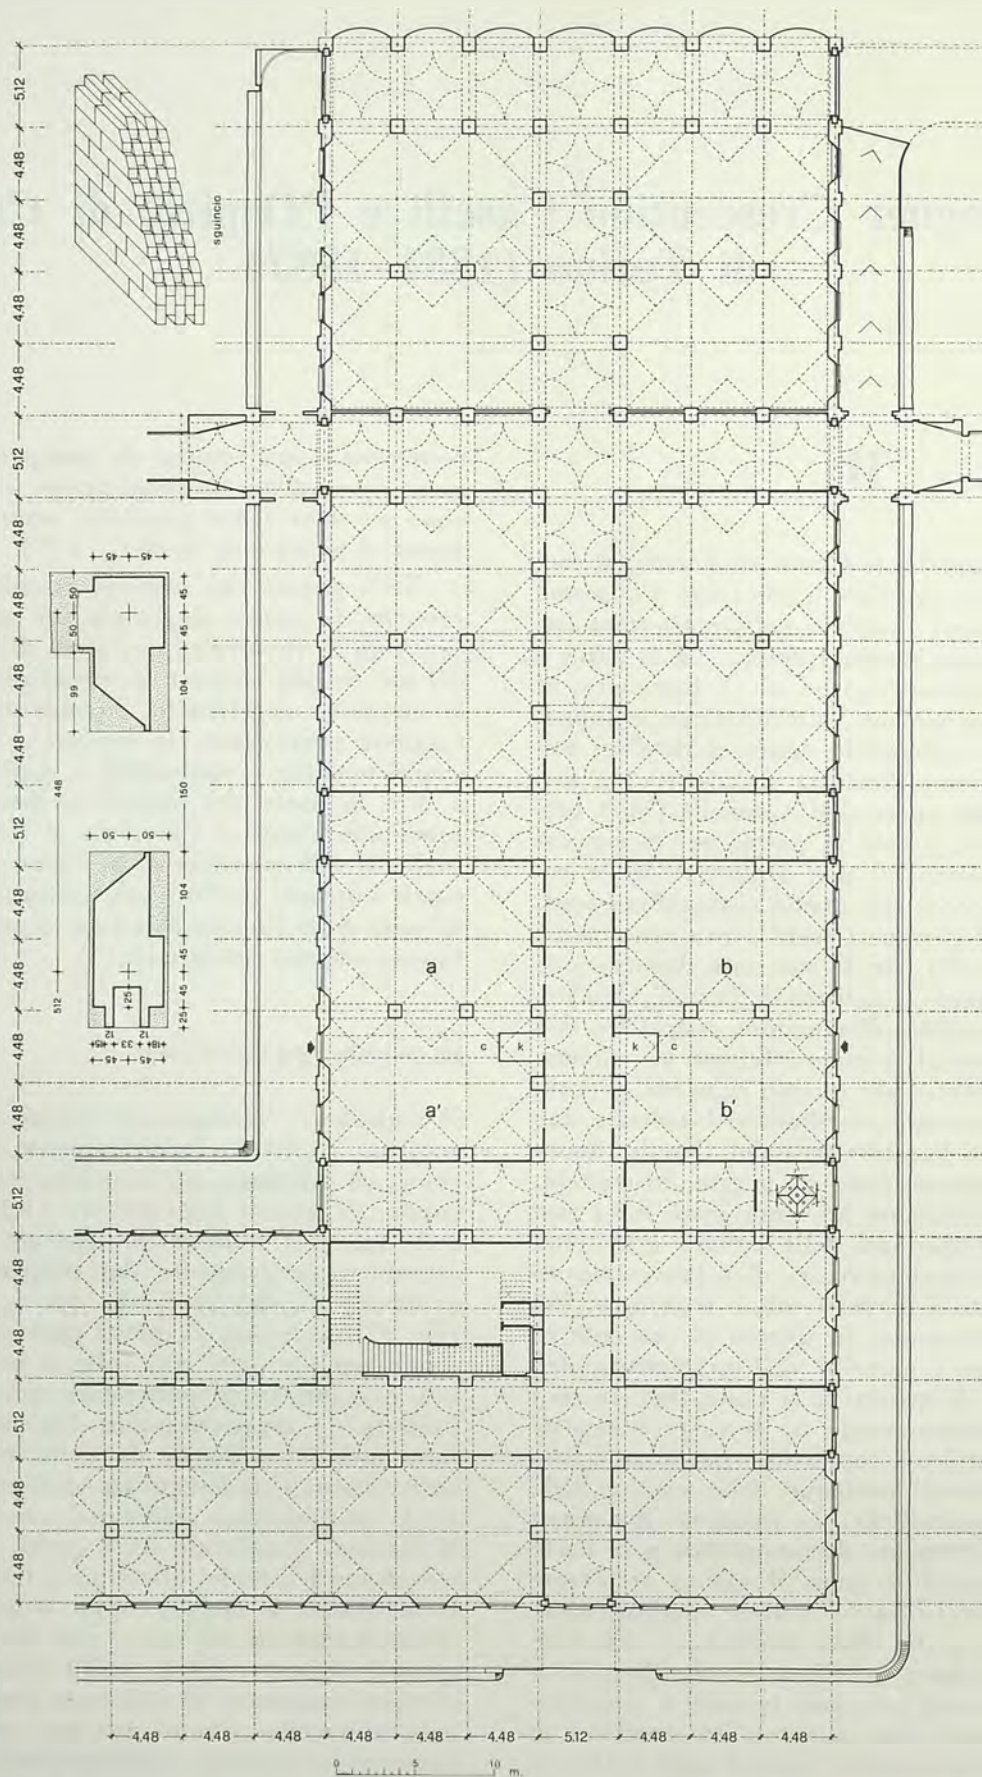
Sotterraneo. Pianta del pad. IX e di parte della manica VIII (diam. dei pozzi di fondazione m 1,50; sez. dei fulcri m 0,90 x 0,90). Il rilievo evidenzia il reticolo regolatore planimetrico e la forma delle volte (le losanghe curvilinee simbolizzano le vele antonelliane). Per non complicare troppo il disegno, si sono omesse le tramezzature secondarie dei grandi vani. Sono pure fedelmente ricostruiti il sistema originario delle latrine (aggruppate a quattro attorno alle canne di scarico), i dispositivi del riscaldamento a vapore, esemplificativamente circoscritti alle due coppie di cameroni a, a' e b, b' (le celle k contengono le batterie condensanti che riscaldano l'aria richiamata dall'esterno attraverso il condotto sotterraneo c). A fianco: rilievo quotato del muro di perimetro sul sodo di fondazione, e assonometria dell'apparecchio antonelliano degli sguinci.
